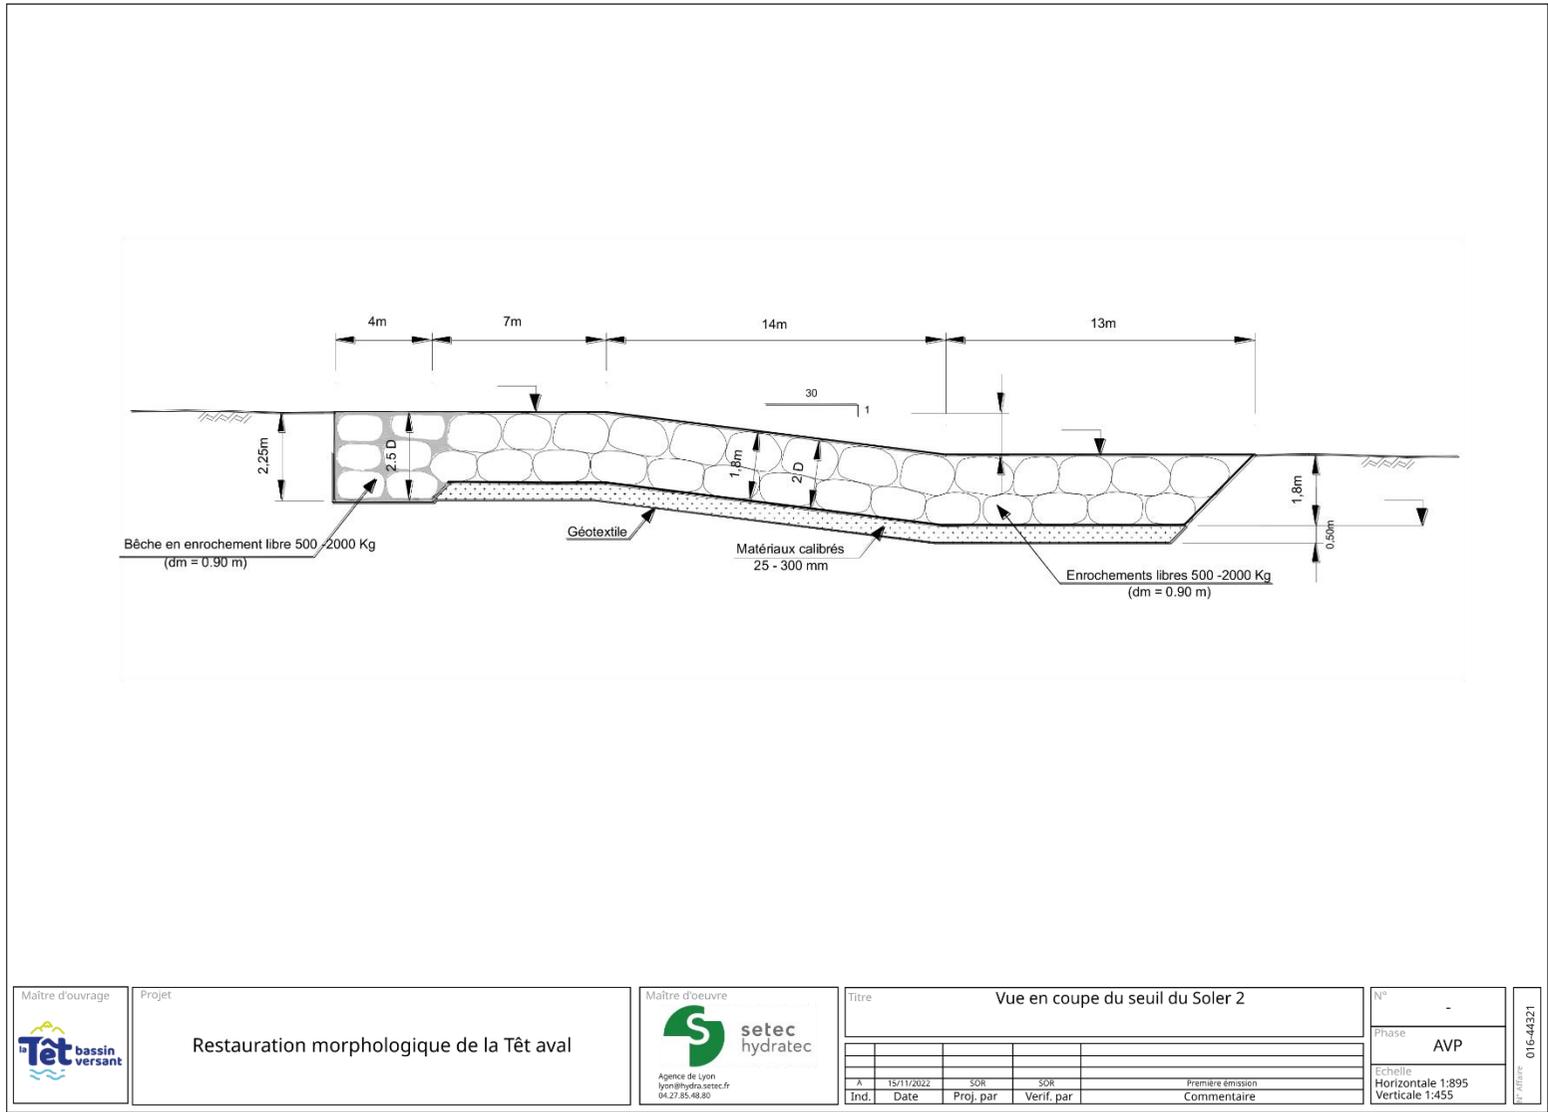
Exemple d'une vue en coupe de l'ouvrage de calage du profil en long localisé au droit du seuil du Soler 2.
